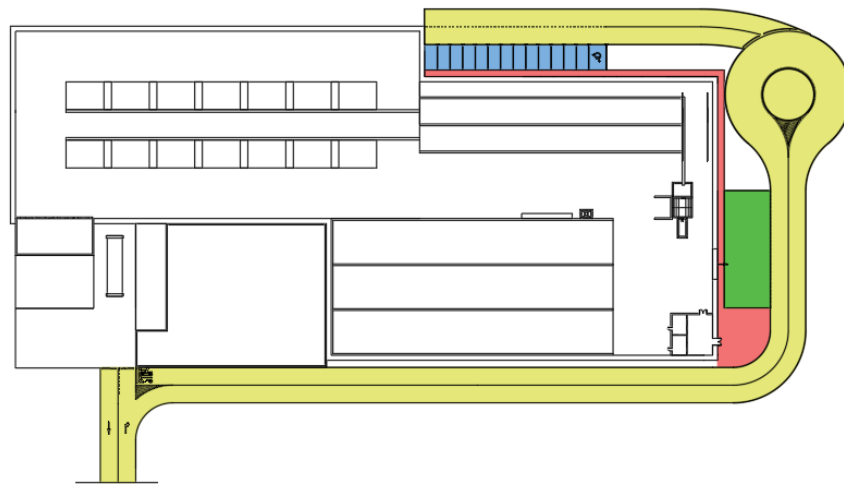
Disposición de la planta, Opción 3. Fuente: Elaboración propia
